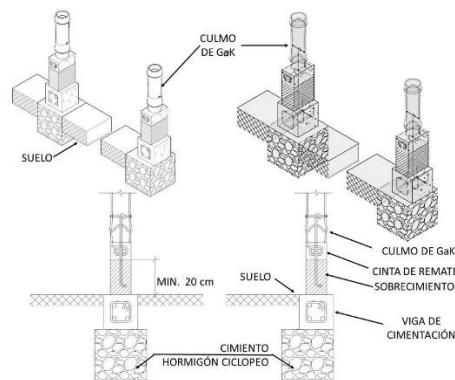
Detalle de cimiento y sobrecimiento (Viga de cimentación)
